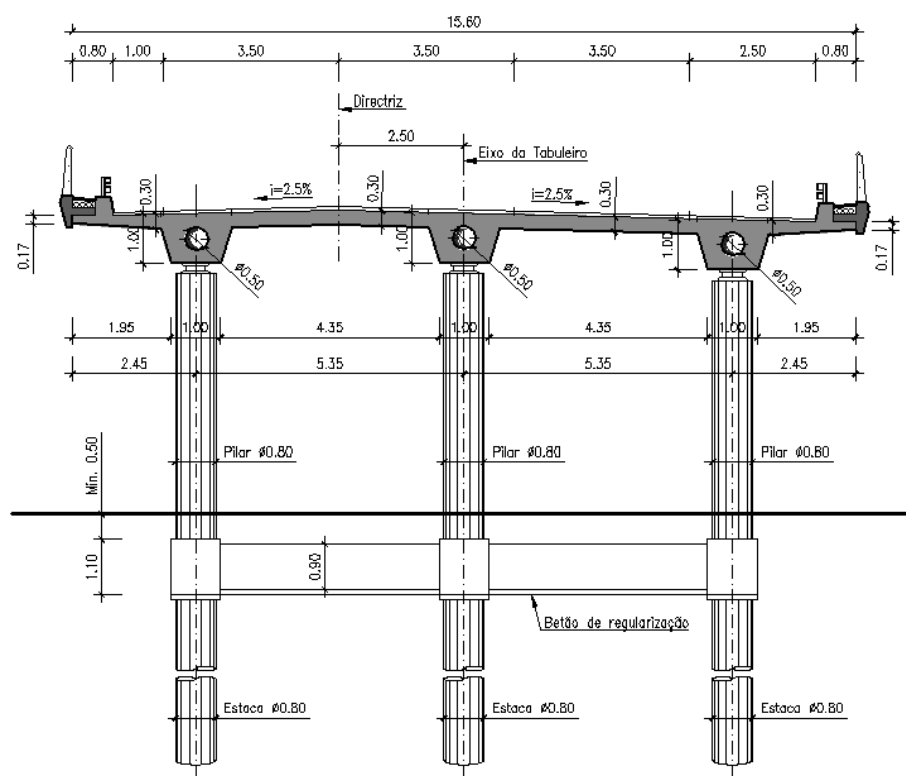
Secção transversal de maior largura do viaduto sobre o IC32 - Solução 1.
